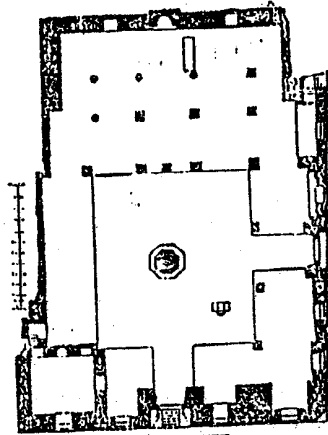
مقطع أفقي للجامع الأزهر بالقاهرة.
